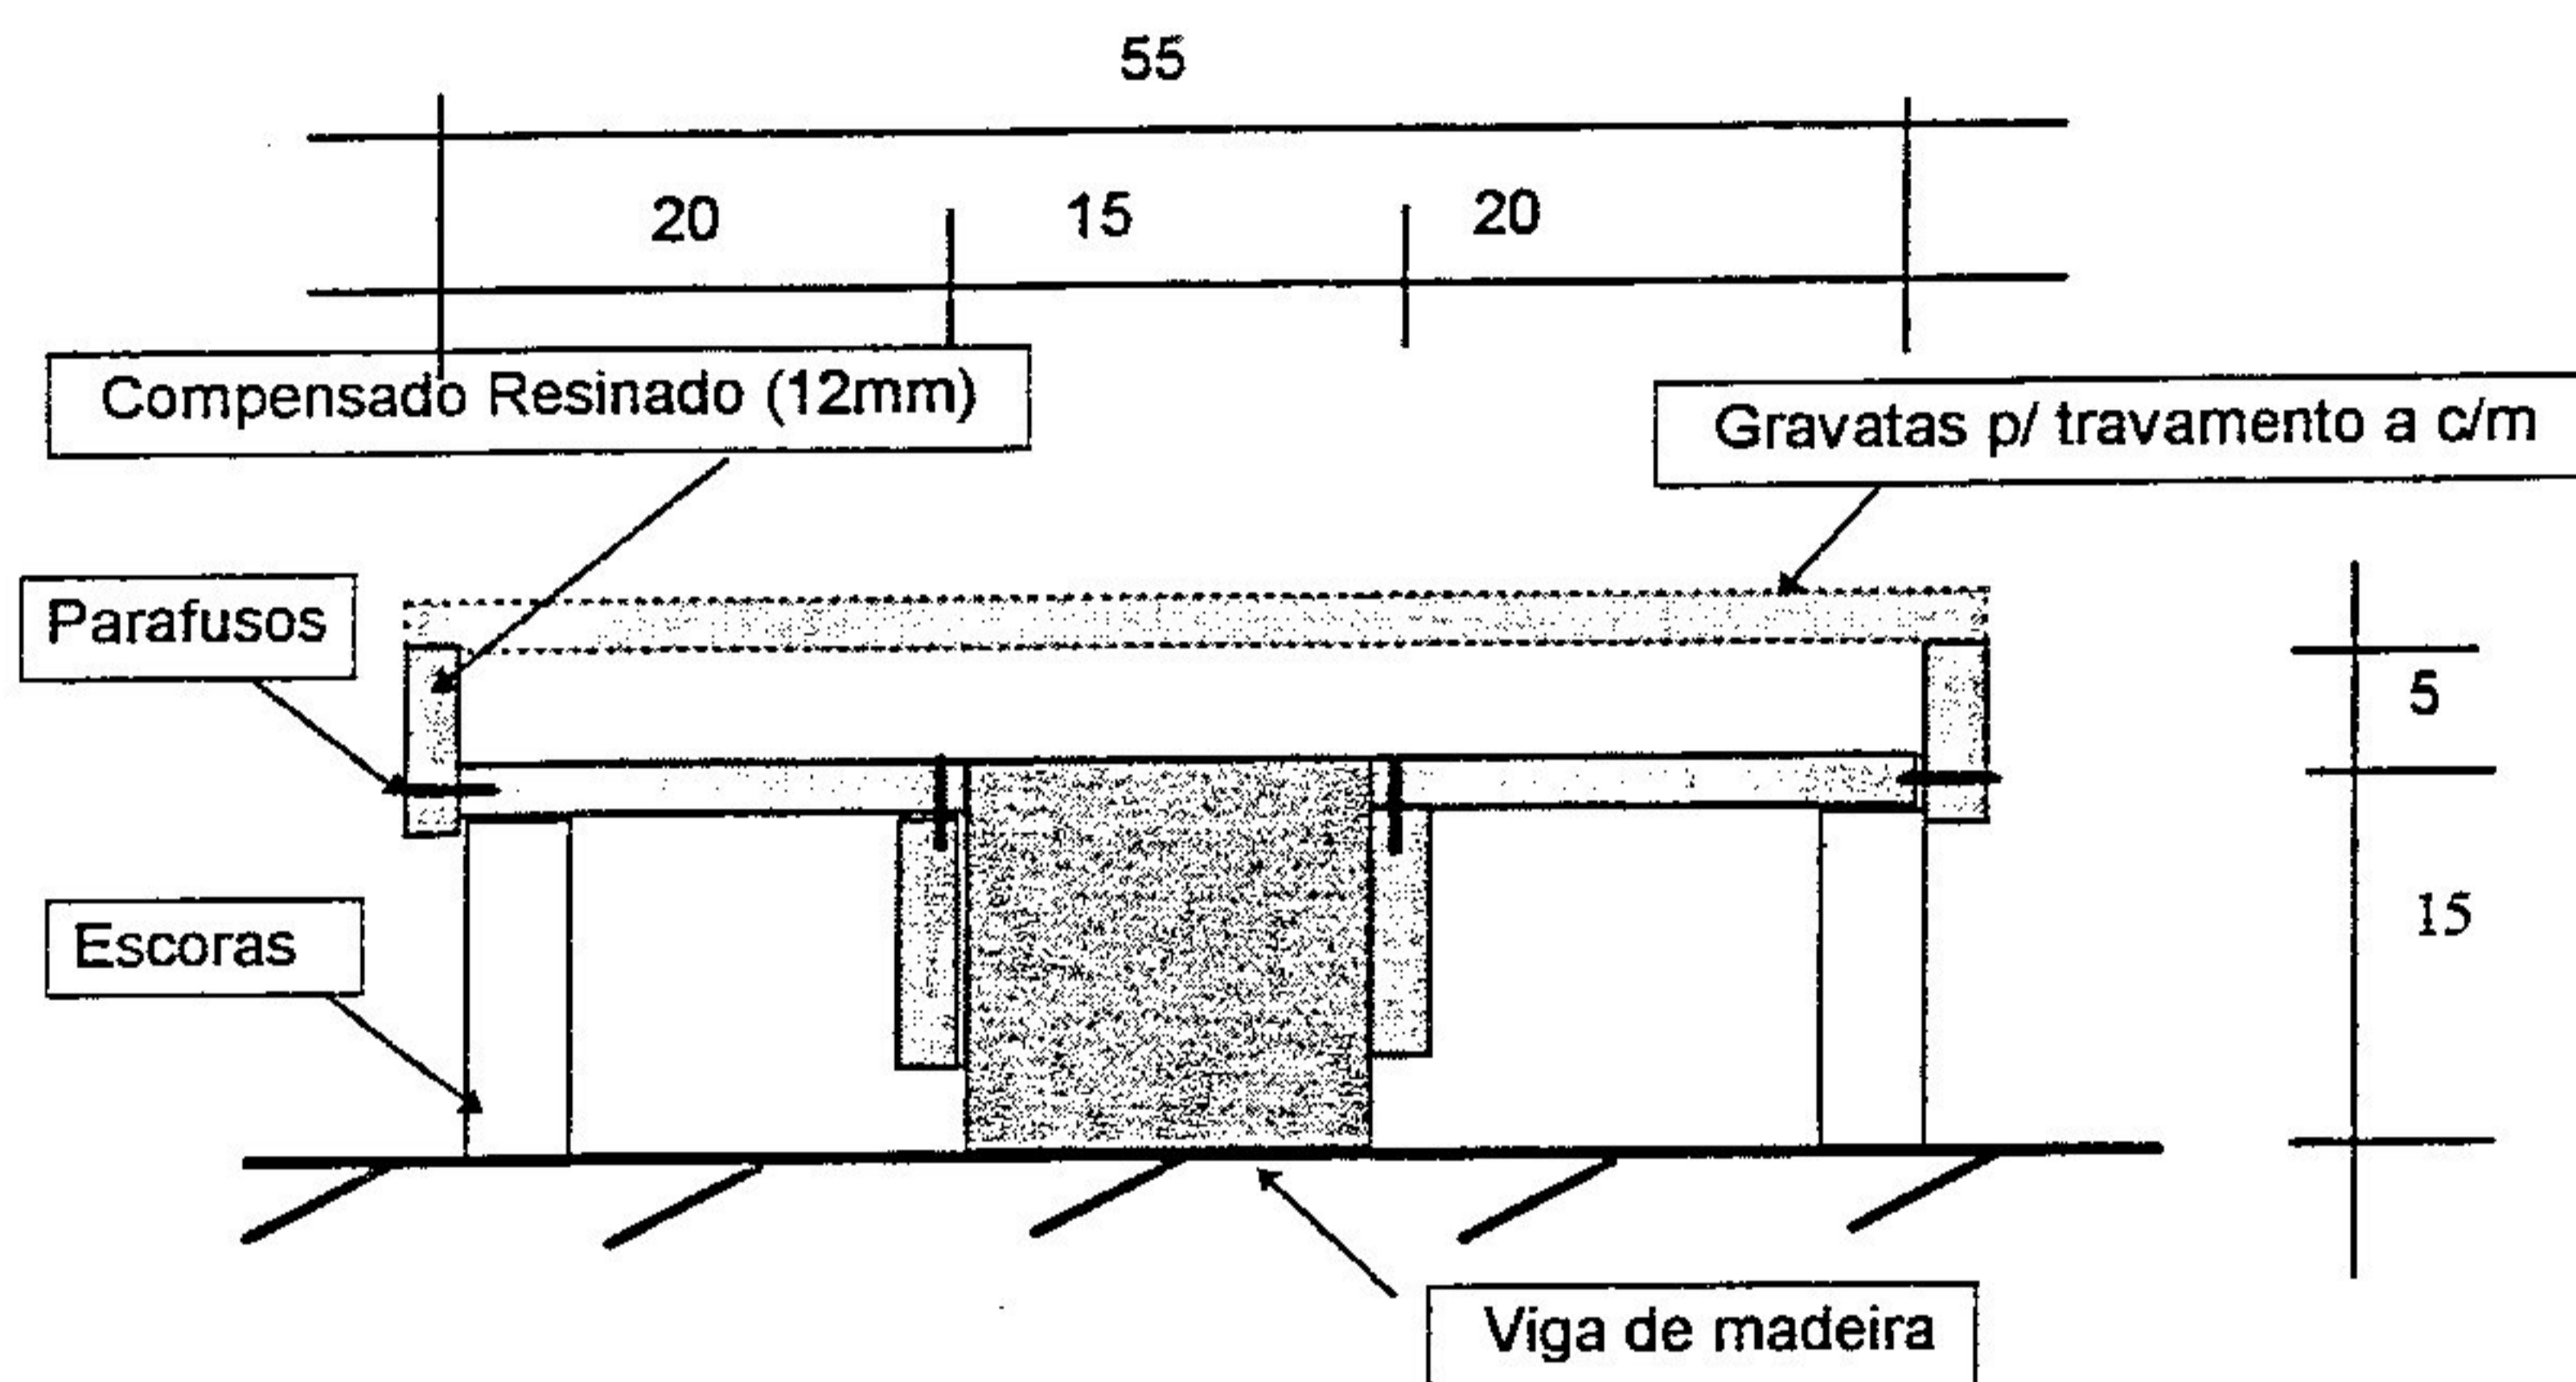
Seção Transversal da Fôrma das mesas de concreto (Dimensões em cm)
